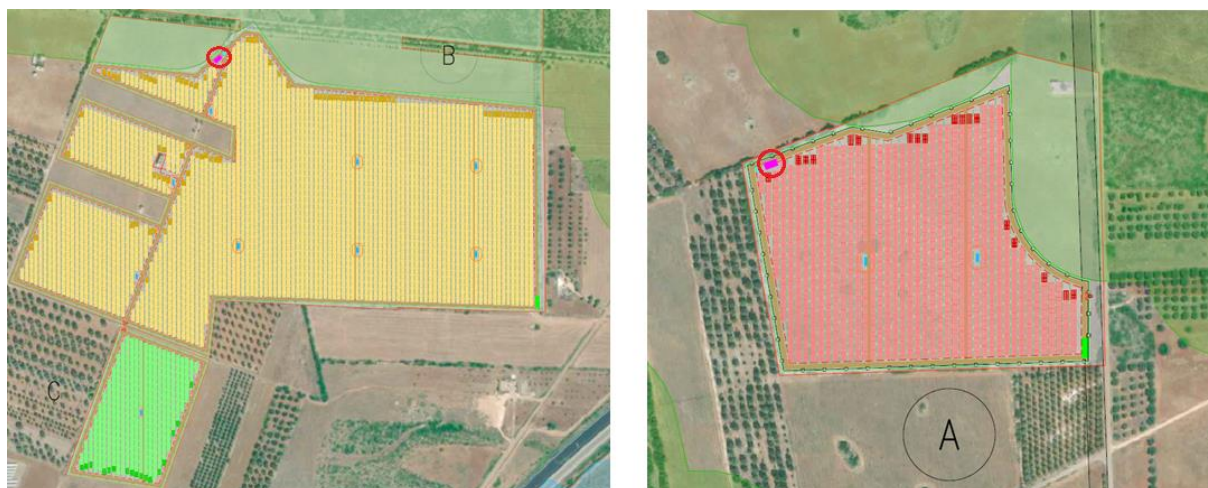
Spazi accessori dell'impianto (particolare delle tavole progettuali), in rosso.
